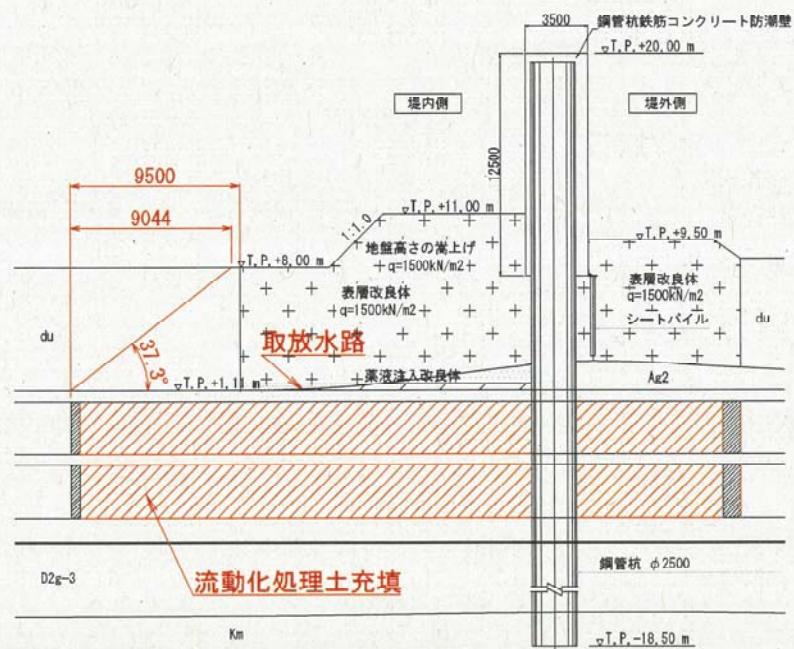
取放水路埋戻し位置断面図 (B-B断面)
